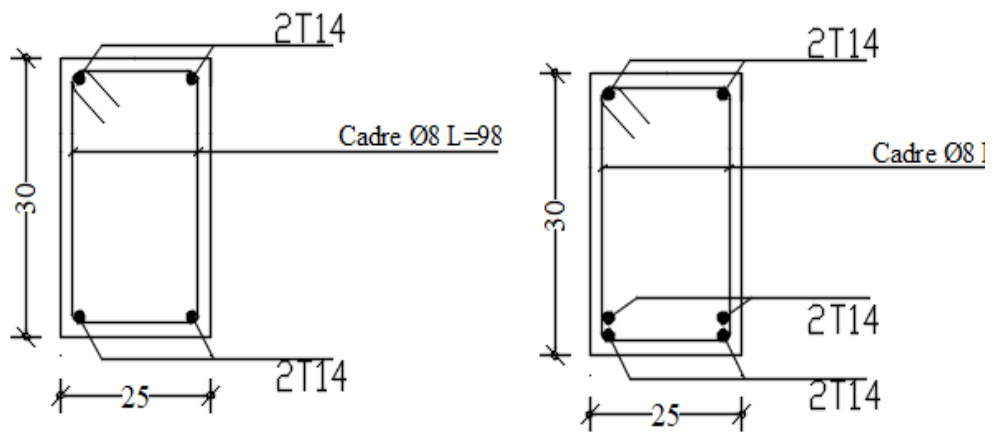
Dessin de ferraillage de la poutre palière
